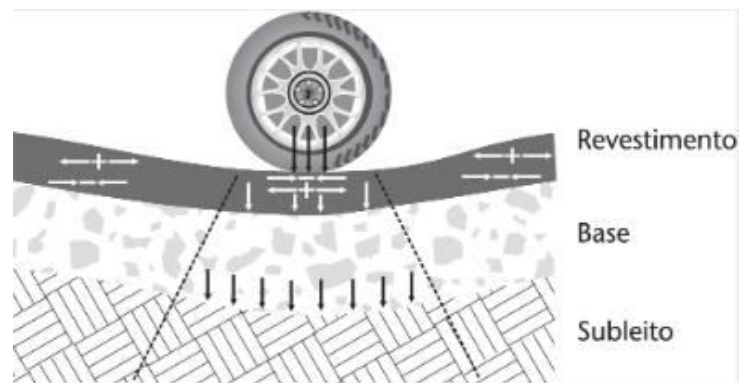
Ilustração do sistema de camadas de um pavimento e tensões solicitantes.
